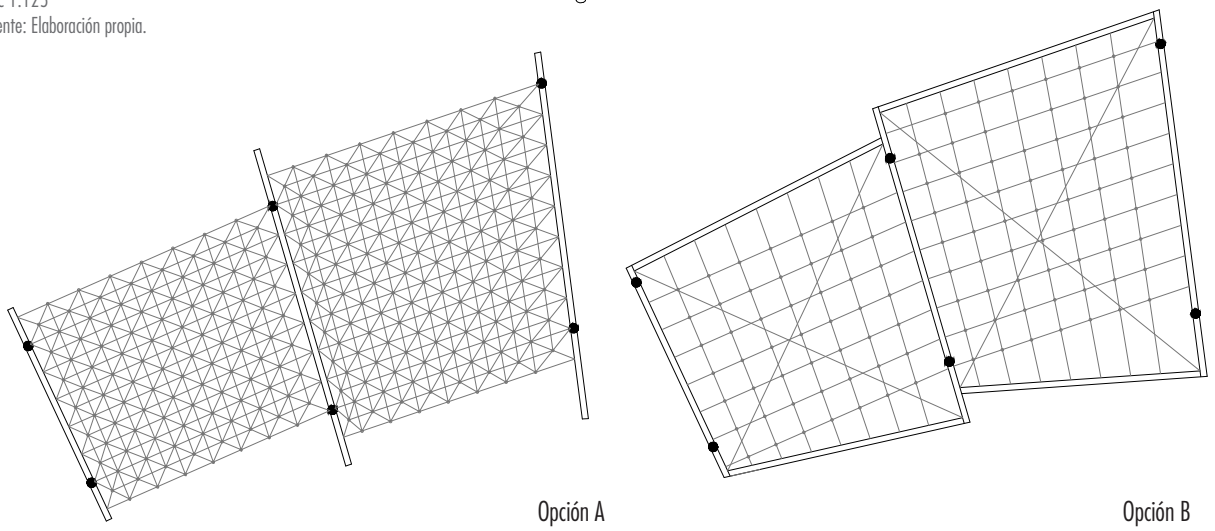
Plantas opciones estructura sombreadero horizontal.
